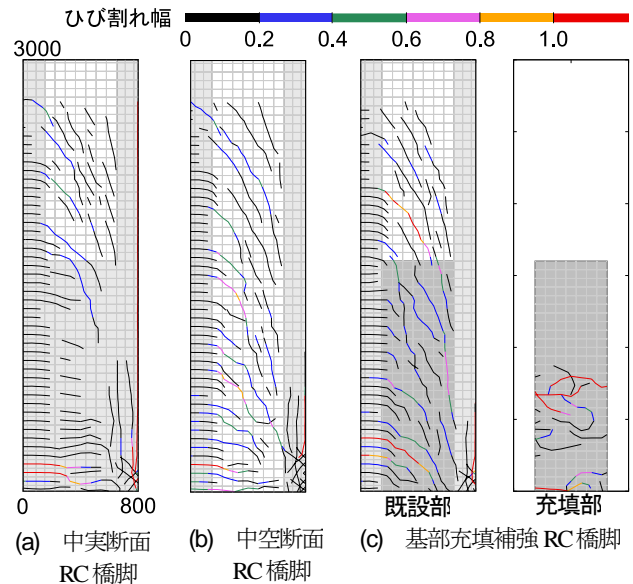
$3\delta y_0$ 時のひび割れ性状(Unit:mm)
